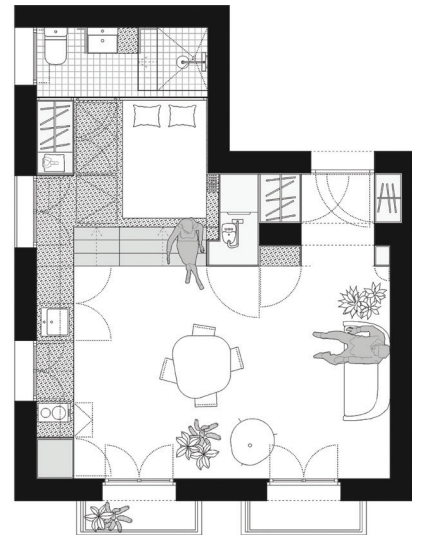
Стан Доместик трансформер, Хонг Конг (Гери Ченг, 2007) (Извор: www.archdaily.com) / Fig. 4. Domestic Transformer Apartment, Hong Kong (Gary Chang, 2007) (Source: www.archdaily.com)
